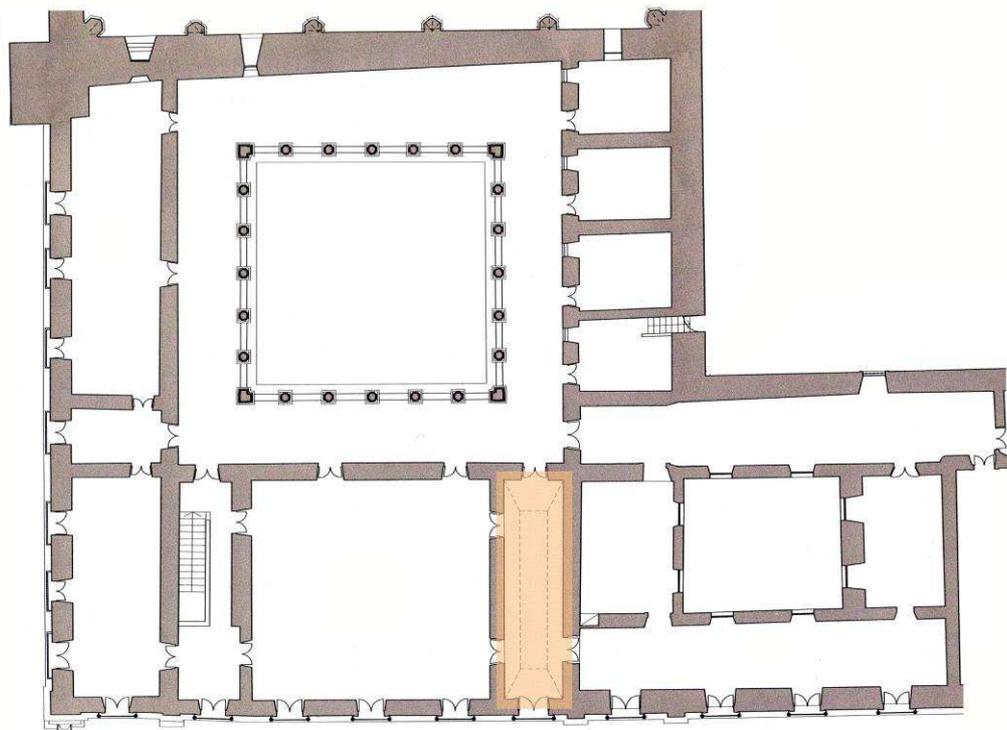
Localização da sala Sul na planta do piso superior do levantamento de 2003.
